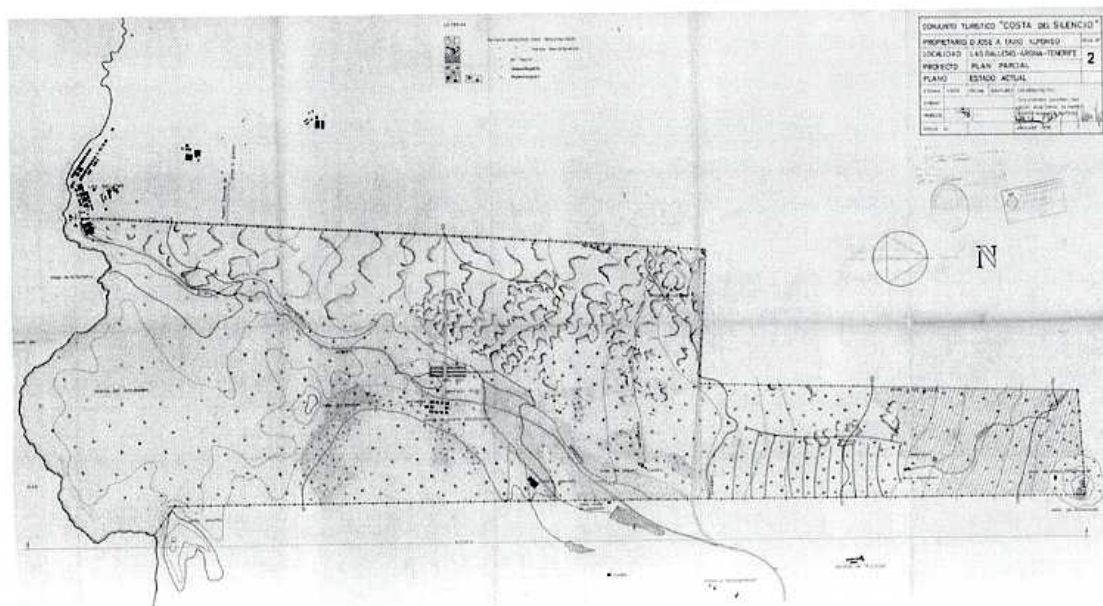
Plan Parcial Costa del Silencio (1963). Plano estado actual.
